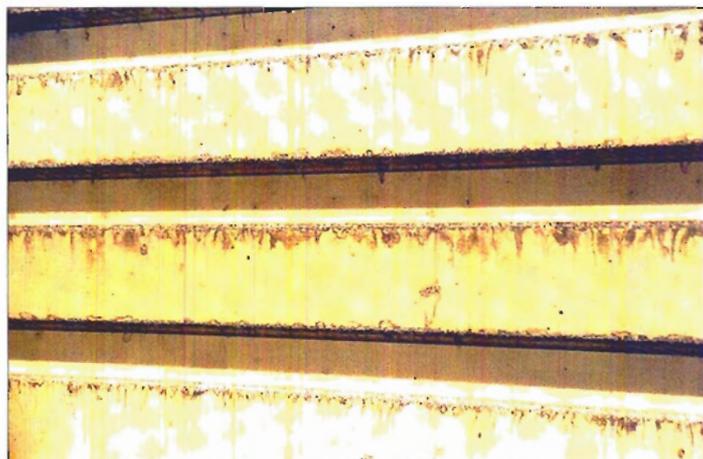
Detalle de una chapa de acero pintado, apreciablemente deteriorada, después de 3 años de estar colocada en un túnel.
